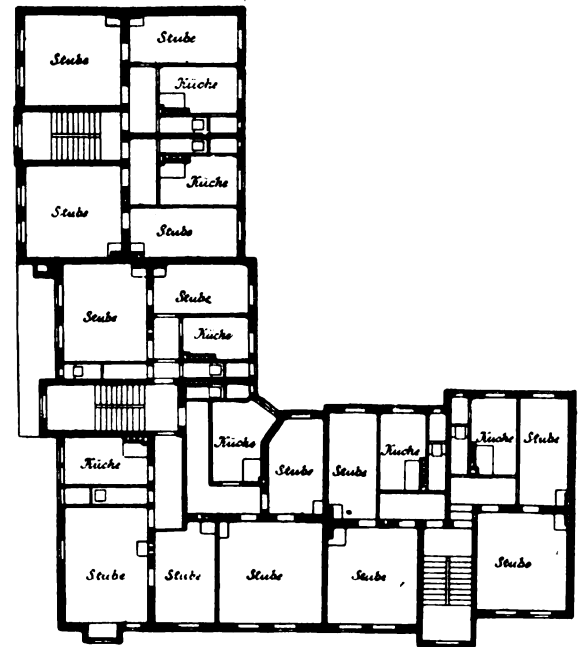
Grundrisse des Hauses an der Eschen- und Ulmenallee. (Keller- bzw. Erdgeschoss und 1. Stockwerk.)
